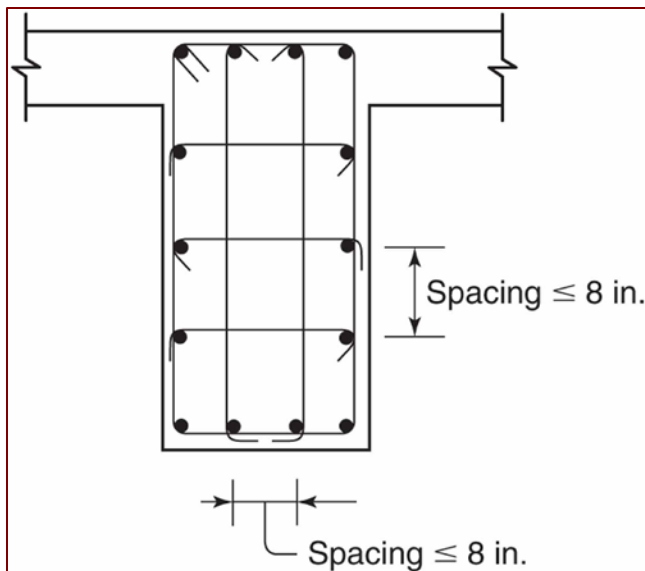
Procedimiento alternativo para refuerzo de confinamiento en vigas de acople.
